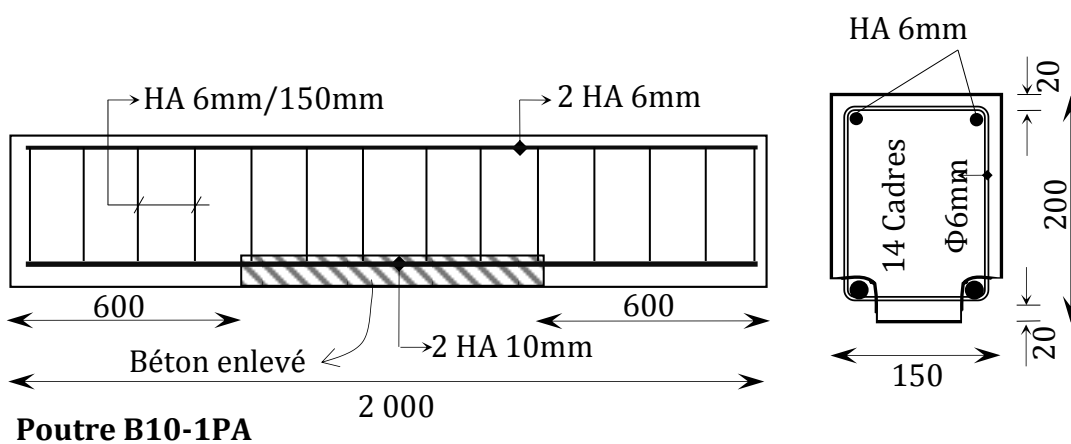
Caractéristiques géométriques et ferrailage des poutres B10. (Toutes les dimensions en mm).
